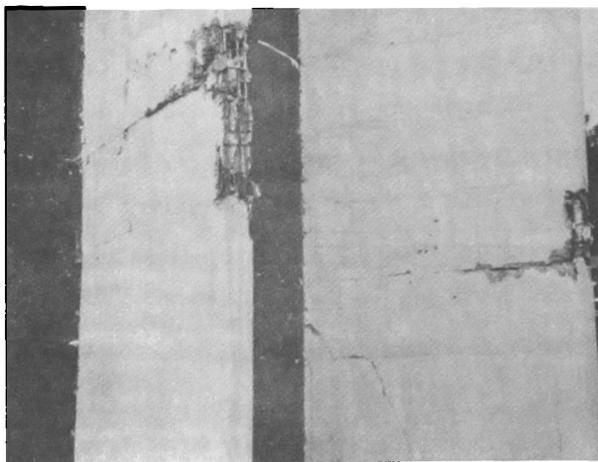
Daños a la altura de los empalmes. Aletas 5, 6, 7, 8 y 9. Estanque elevado.
